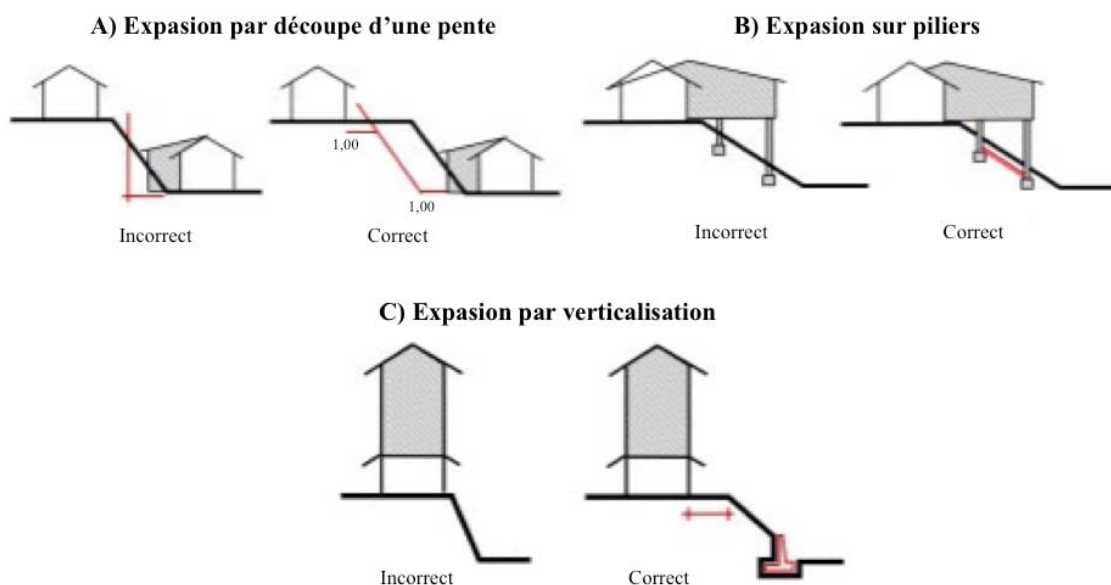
e Photo 3-25 : Expansion par découpe des flancs de colline
